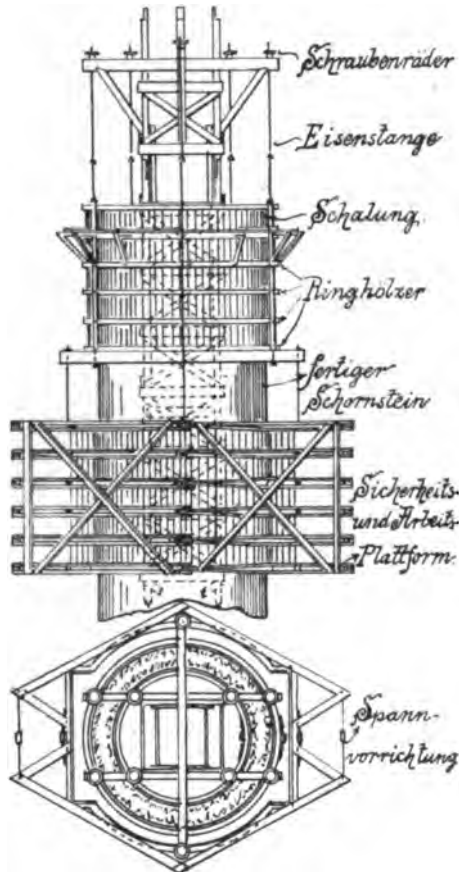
Stampfgerüst zu einem Schornstein aus Eisenbeton.
